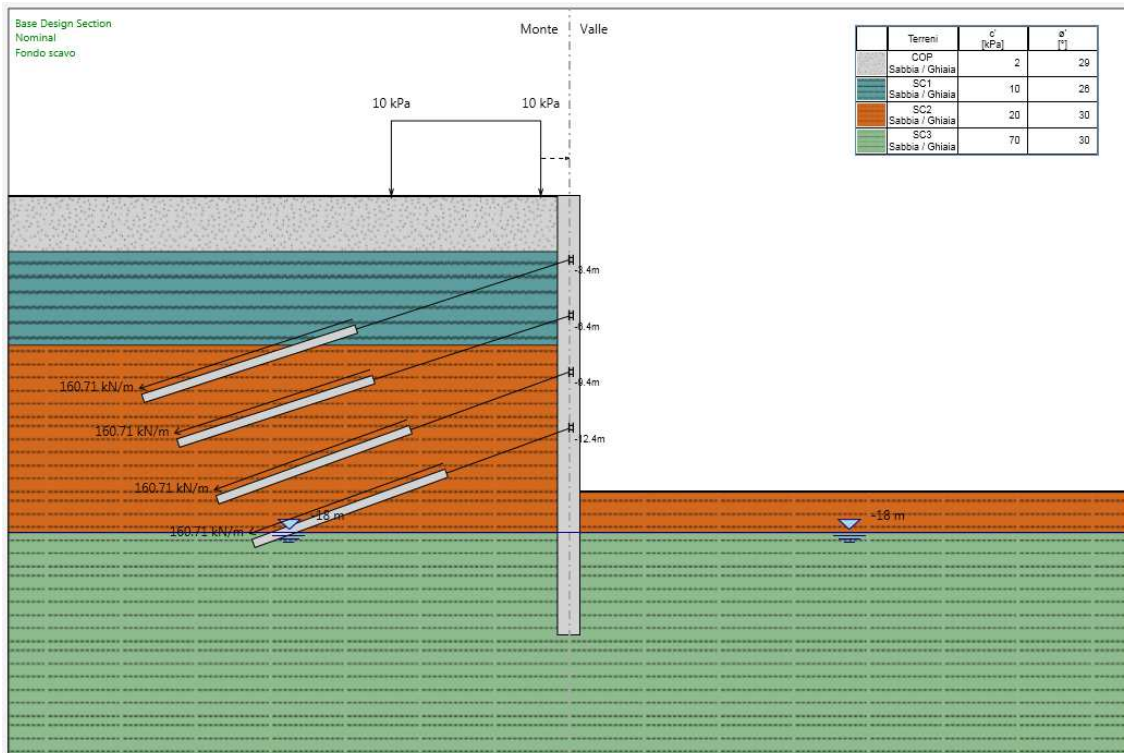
Modello di calcolo sezione – Step FONDO SCAVO
